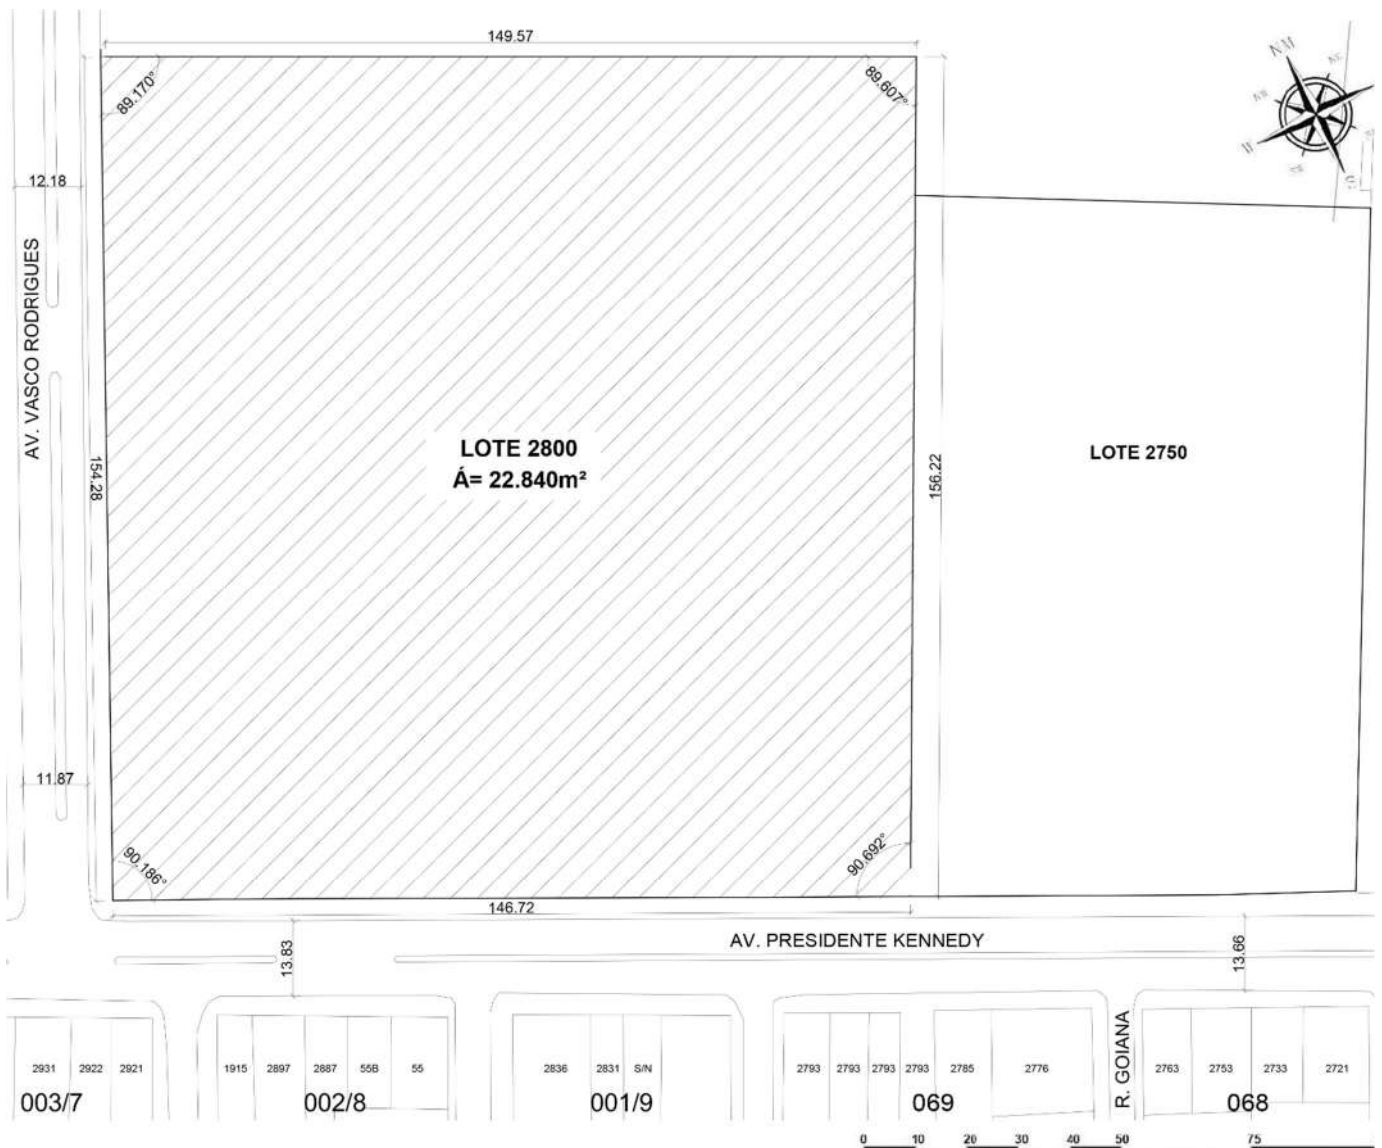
Planta de Situação do terreno de implantação do empreendimento.
